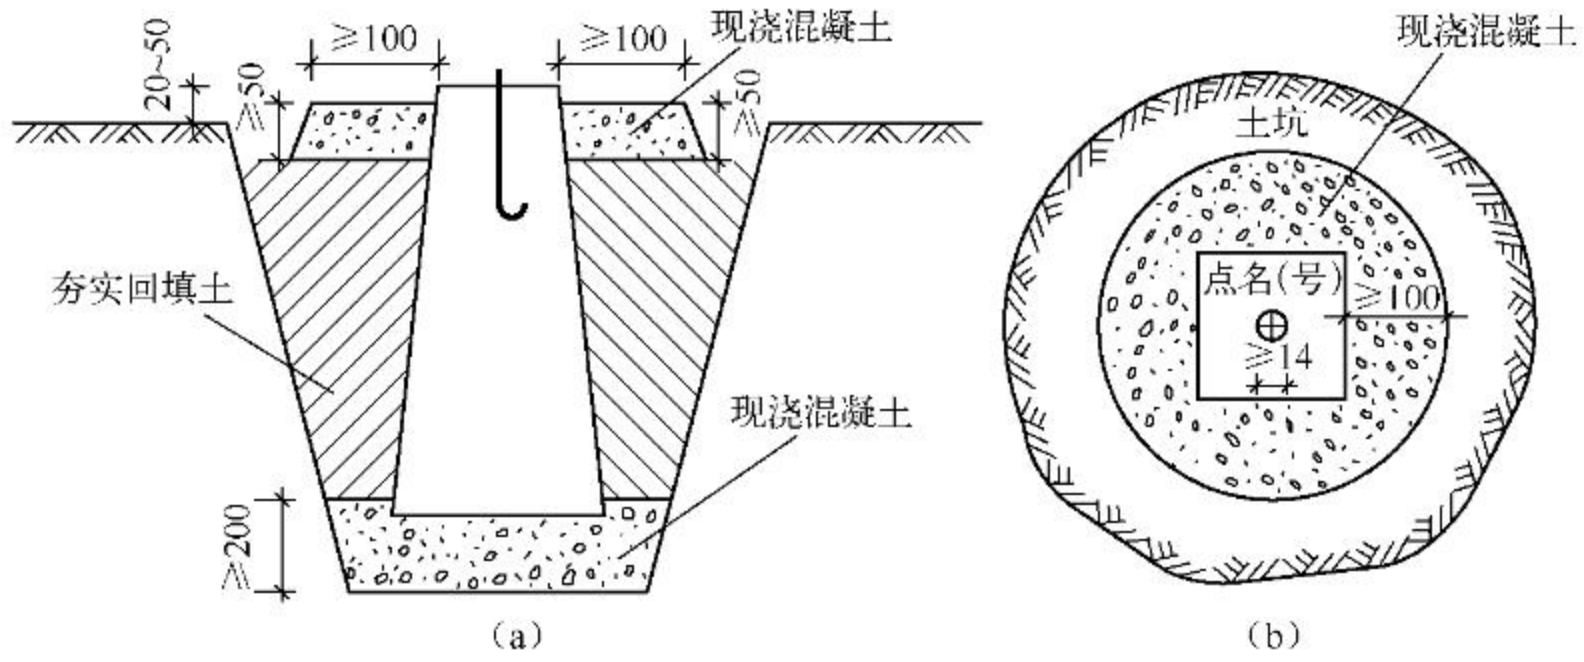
控制测量桩埋设剖面图 (单位: mm)
